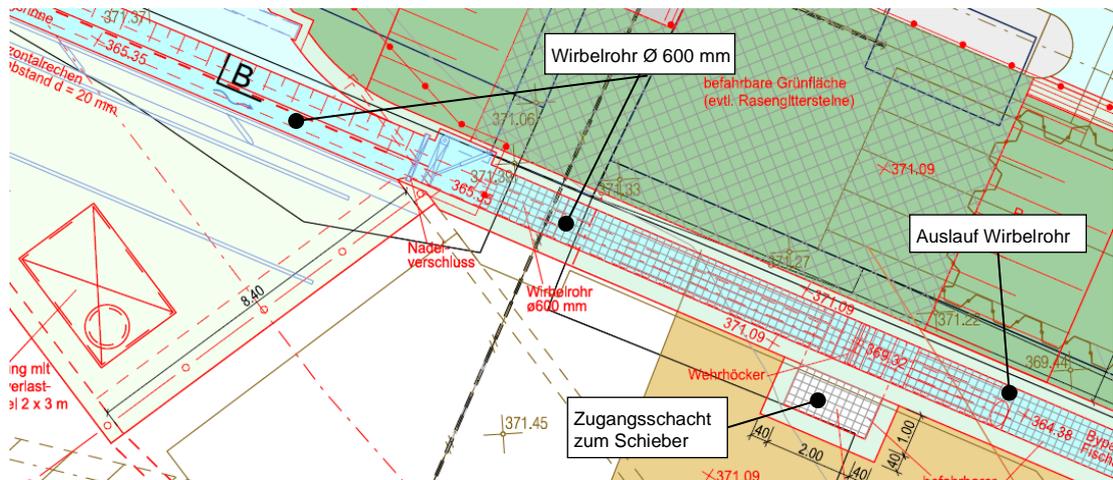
Situation Bypass mit Wirbelrohr (Auszug Plan P.33N.045, IUB 2019)
